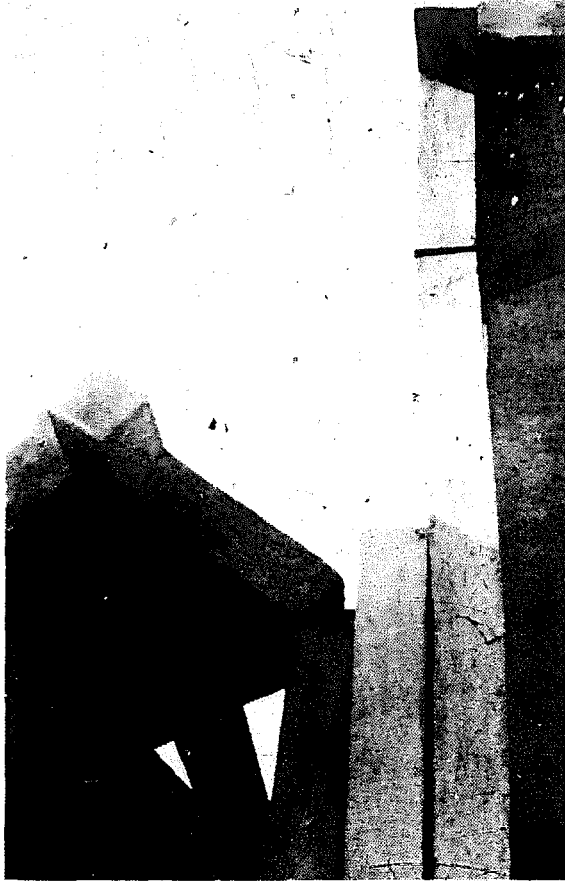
Rotura de las columnas por la base de la viga superior.
